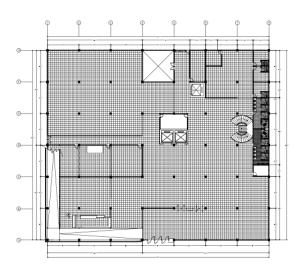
denah Rencana jendela Lantai 2 Sumber: dokumen pribadi
